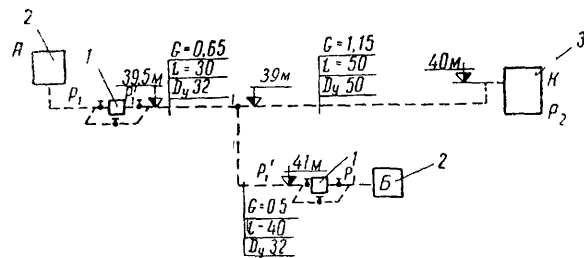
Расчетная схема сборных конденсатопроводов
